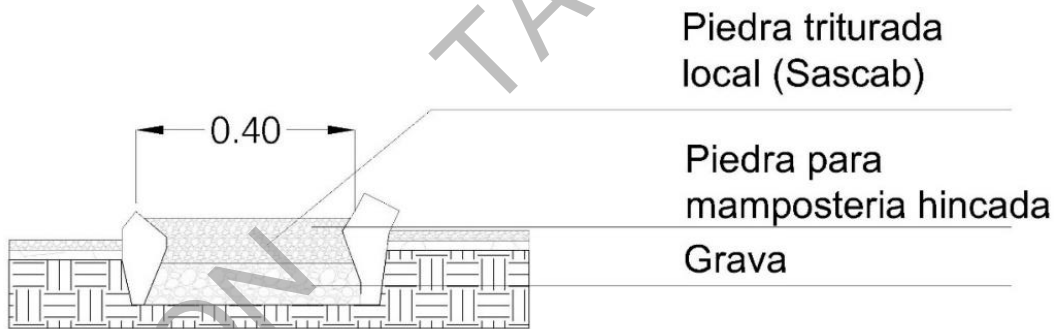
Detalle tipo de la sección transversal del sendero peatonal.
